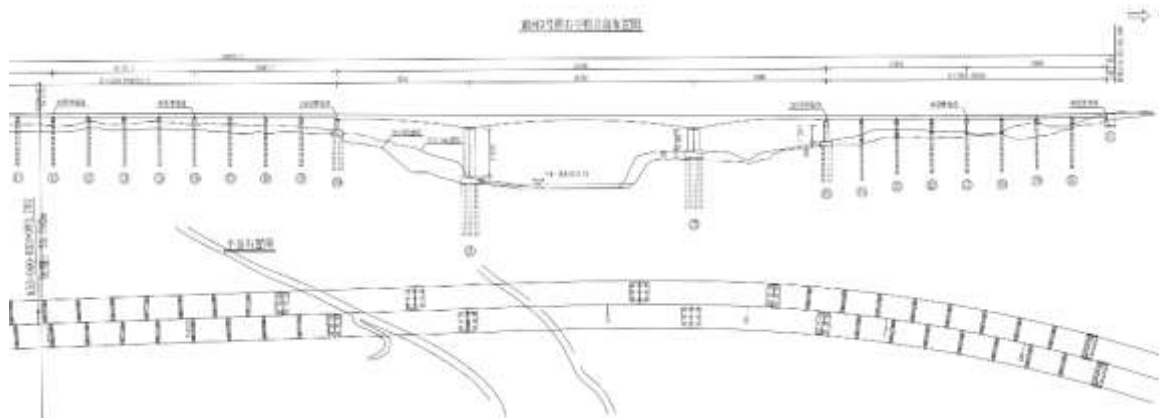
南河三号特大桥（右幅）立面布置图
